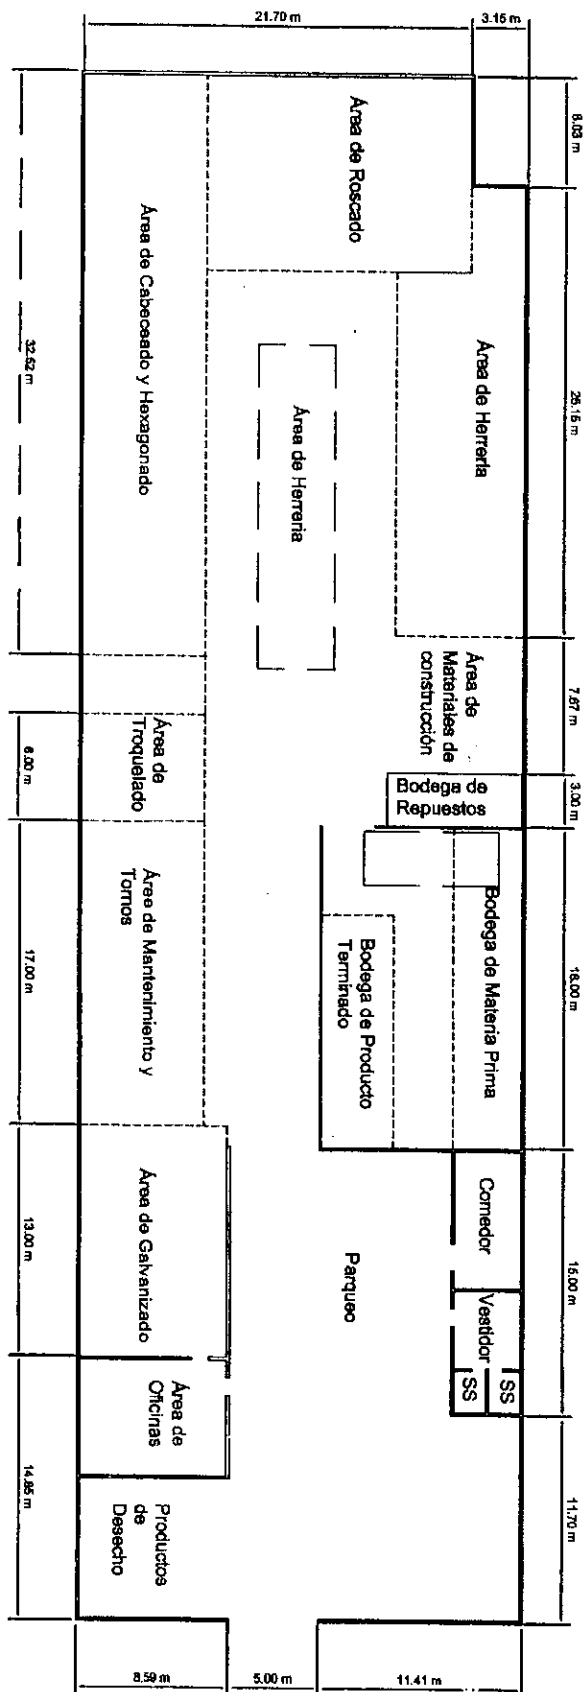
Plano actual de distribución de la maquiagua, vista planta
